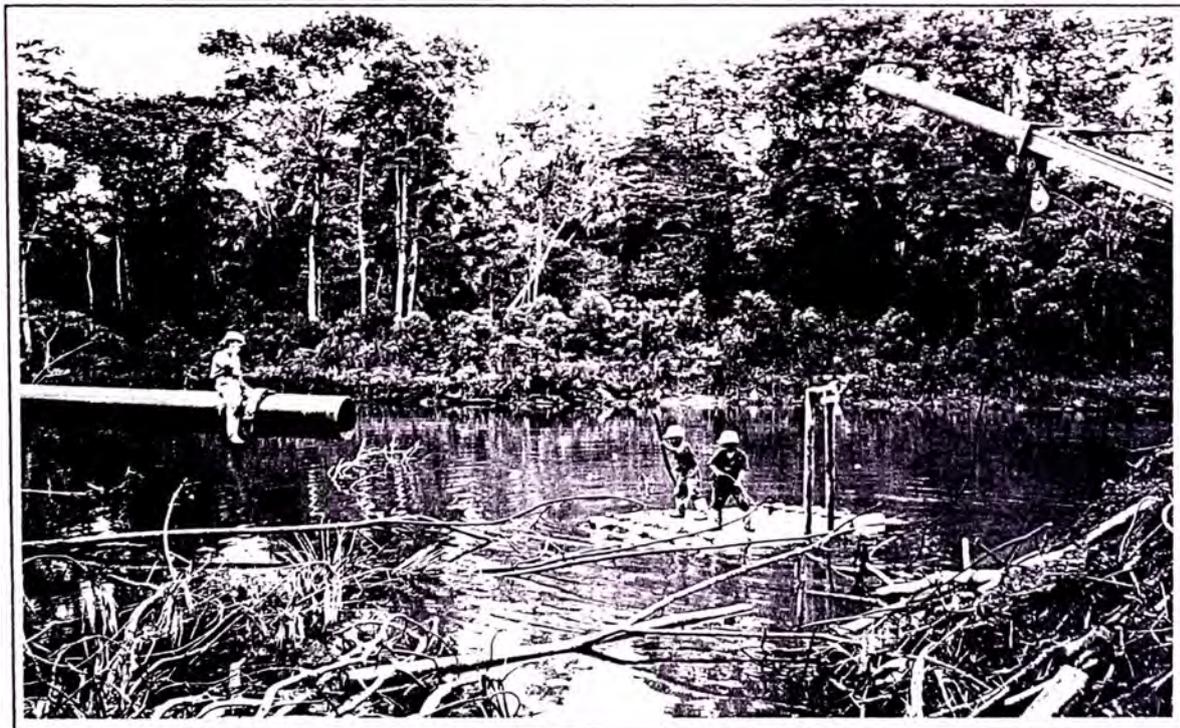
El Side-boom al otro extremo baja cables para que los unan a la correa que envuelve la tubería.
